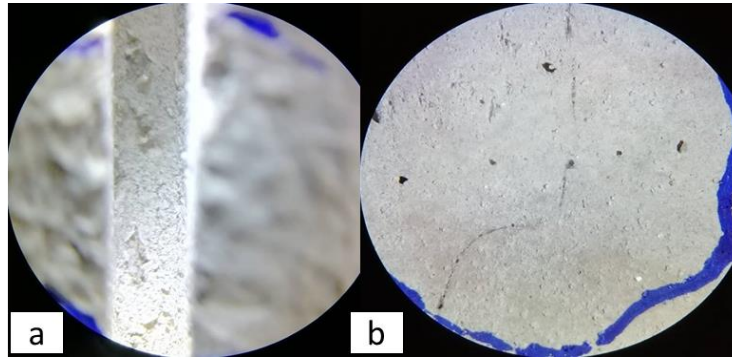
Probeta Piedra 4 2b 2. (a) vista interna de la fisura inducida (b) vista de discontinuidades y fisuras con contracción y secado presentes en el concreto. Evaluación a los 14 días.
